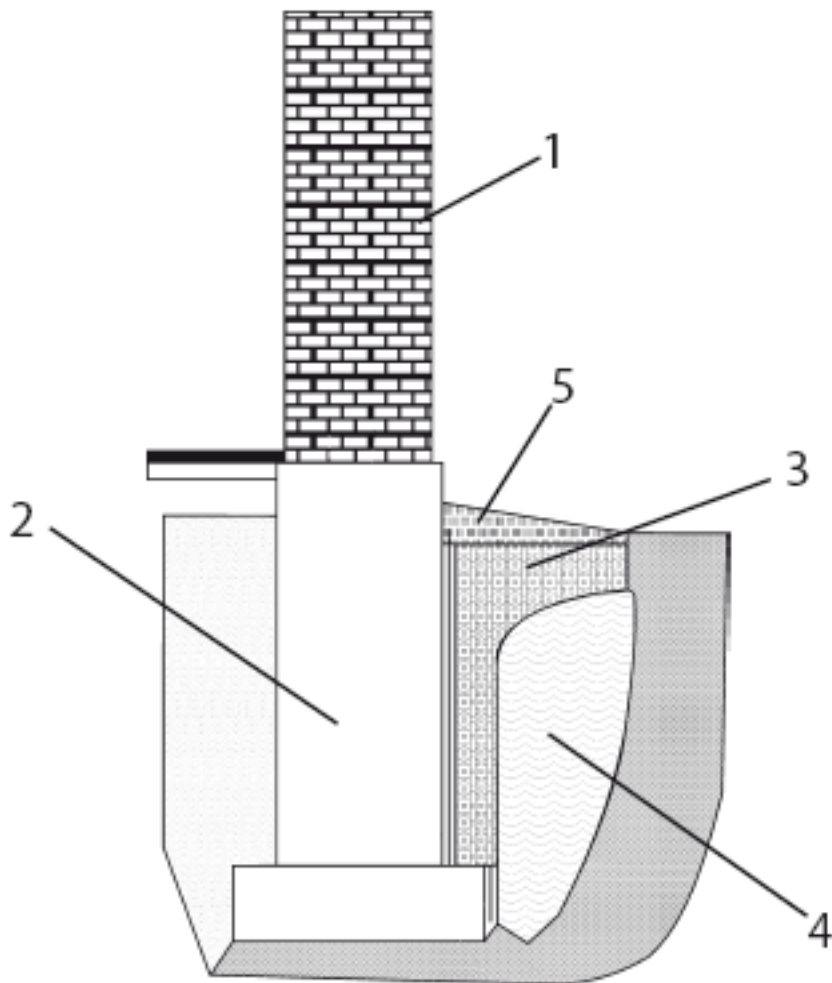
Утепление фундамента: 1 – стена; 2 – фундамент; 3 – утеплитель; 4 – песок; 5 – отмостка
